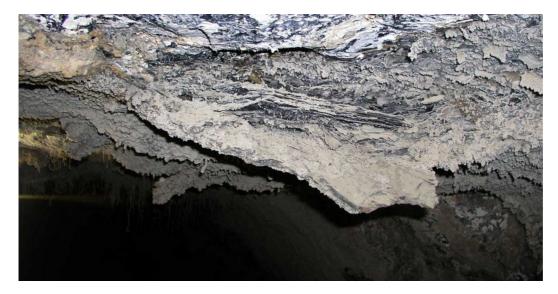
Plaquettes de calcaire en cours de décollement au plafond de la galerie.
